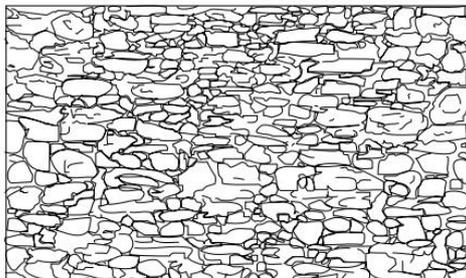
Abaco delle murature irregolari – Pietra arrotondata [14]
